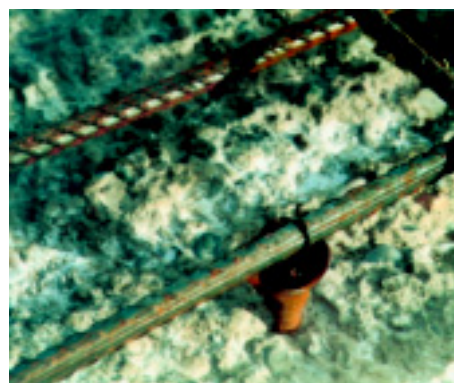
Tiefere Lage der Bewehrungslage auf einem Montagestab
